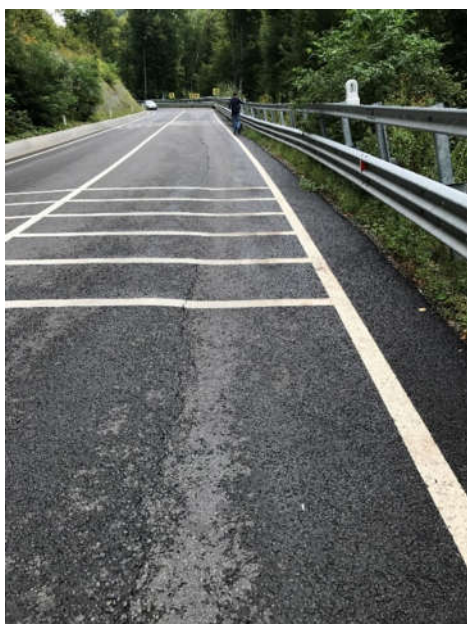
Poză cedare structură rutieră km 9+100 - septembrie
